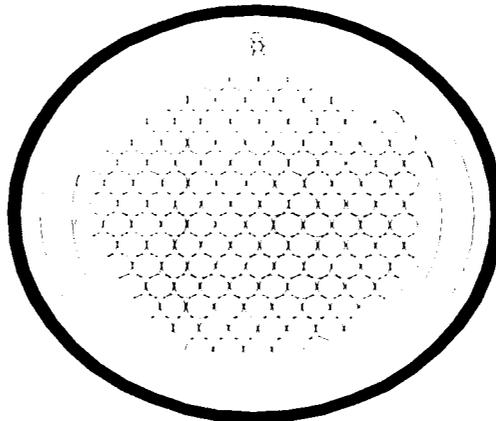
7 Sección transversal del cable de alambres paralelos "PWC"
